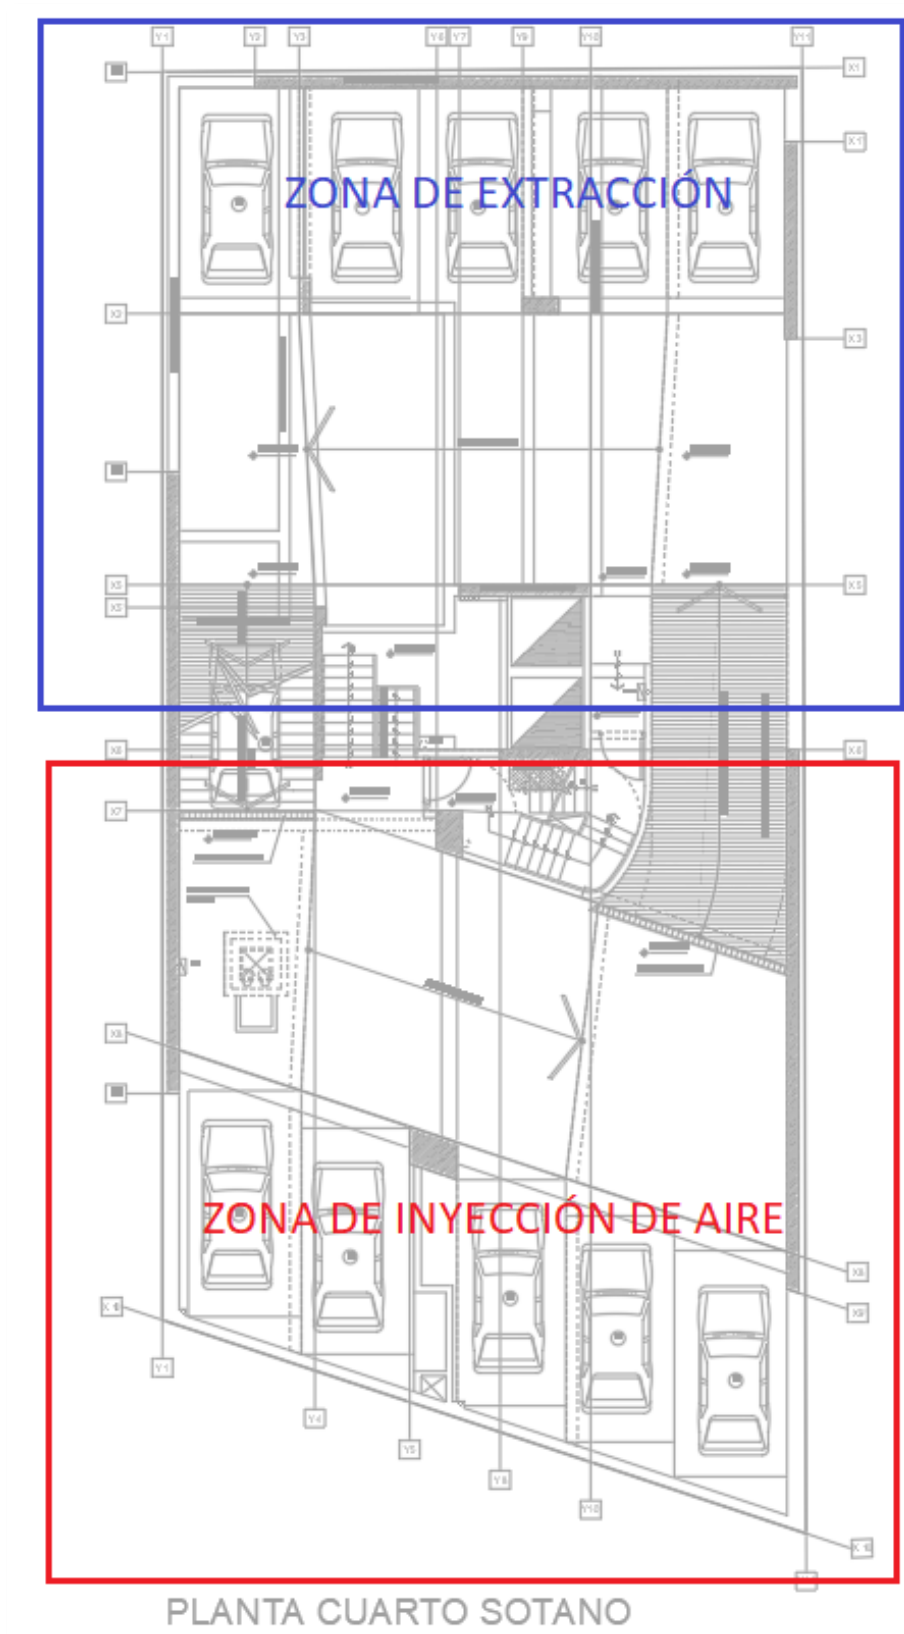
Plano de Planta Sótano 4. Tomado de los planos de arquitectura del proyecto en AutoCAD.
